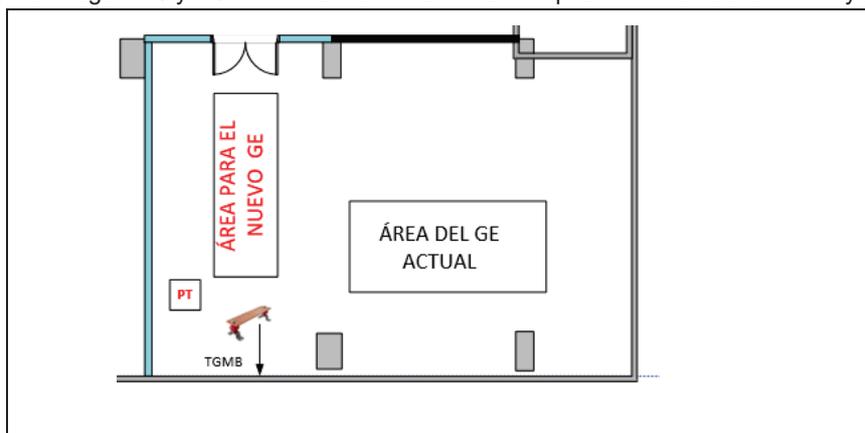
Ubicación de un pozo de puesta a tierra en el Área de Washington
